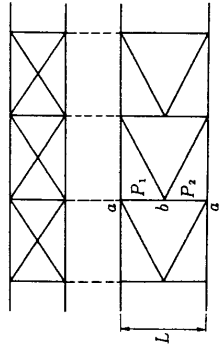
軸力の異なるトラス部材の面外有効座屈長
